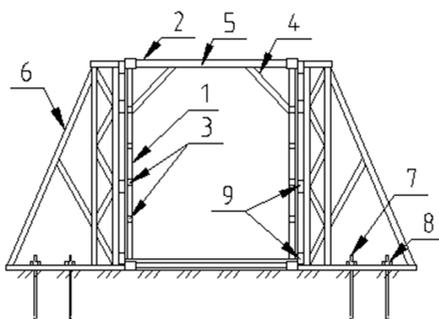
Поперечный разрез базового блок-модуля с элементами усиления: 1 — вертикальные стойки; 2 — наружный профлист; 3 — горизонтальные балки; 4 — наклонные балки; 5 — поперечные балки усиления перекрытия; 6 — контрфорсы; 7 — анкера; 8 — гайки; 9 — соединительные фланцы
